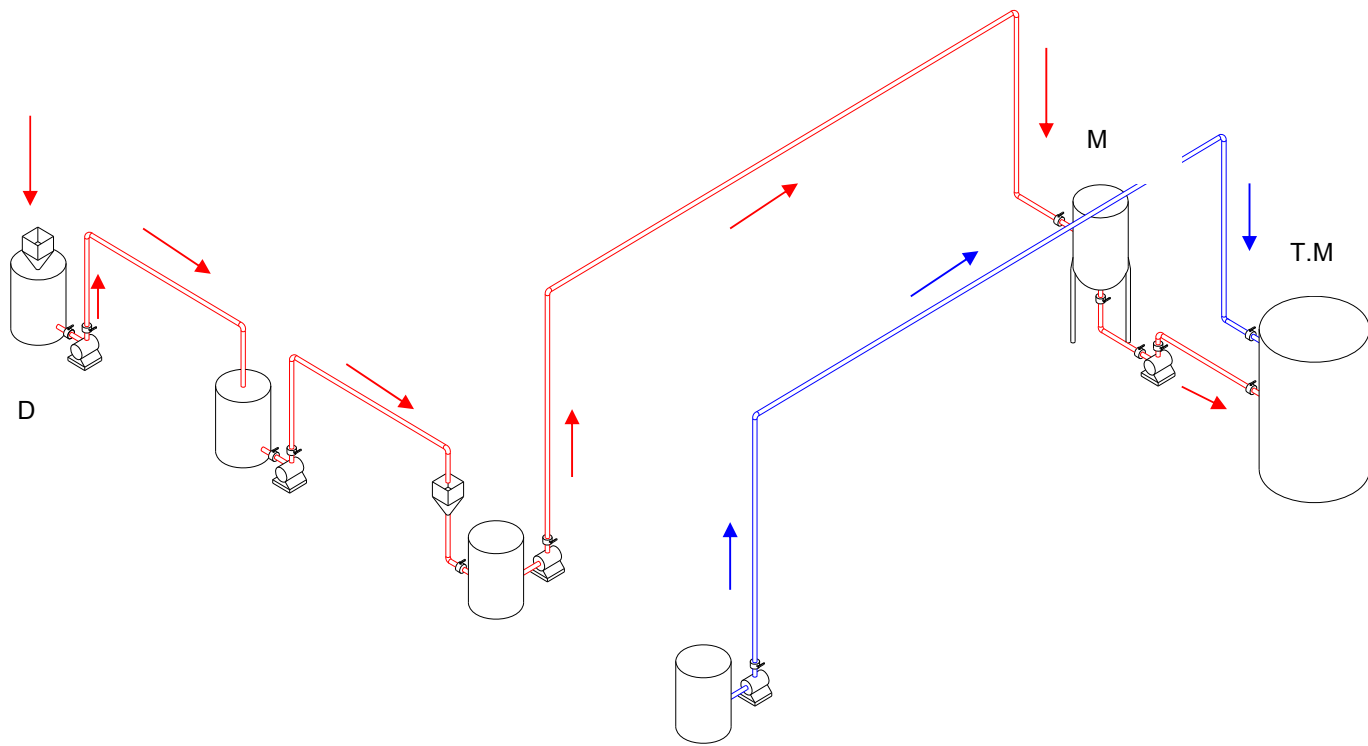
PLANO ISOMETRICO DE LA PLANTA PROCESADORA DE NECTAR DE MANGO
